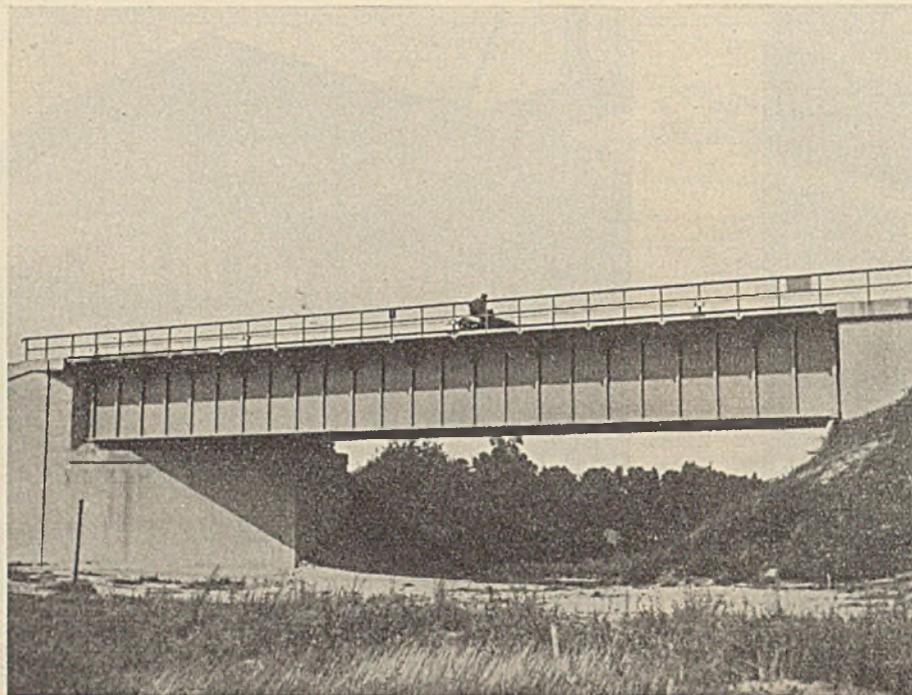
Geschweißte Eisenbahnbrücke.
